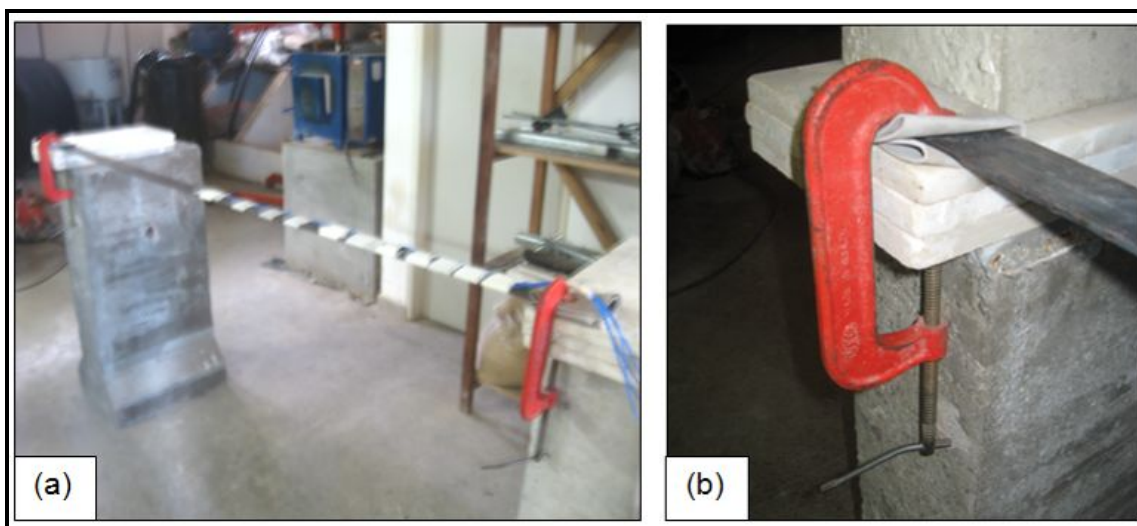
(a) Viga bi-engastada; (b) Detalhe da viga engastada pelo "sargento"
